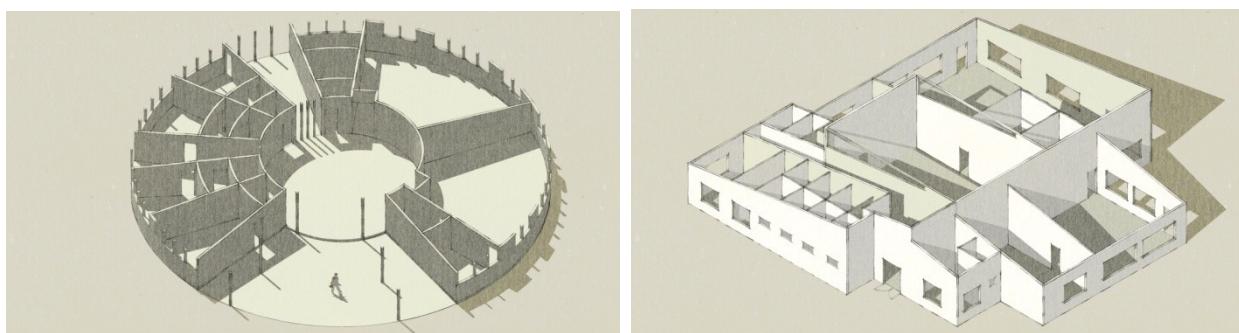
Vistas tridimensionales. Propuesta planta redonda y cuadrada.
